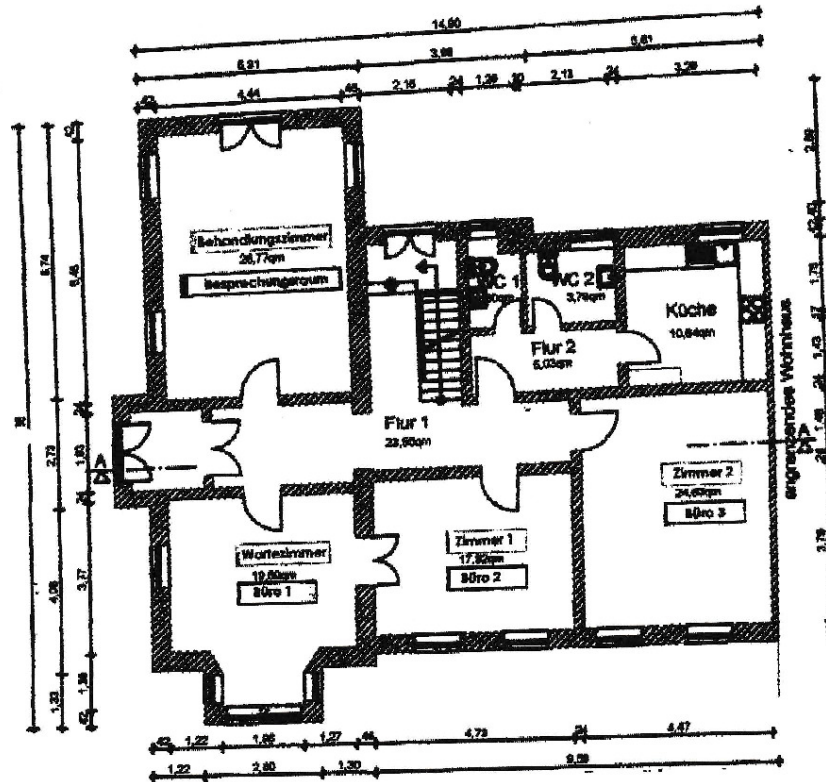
Grundriss Erdgeschoß, Hostatostrasse 26, 65929 Frankfurt am Main
